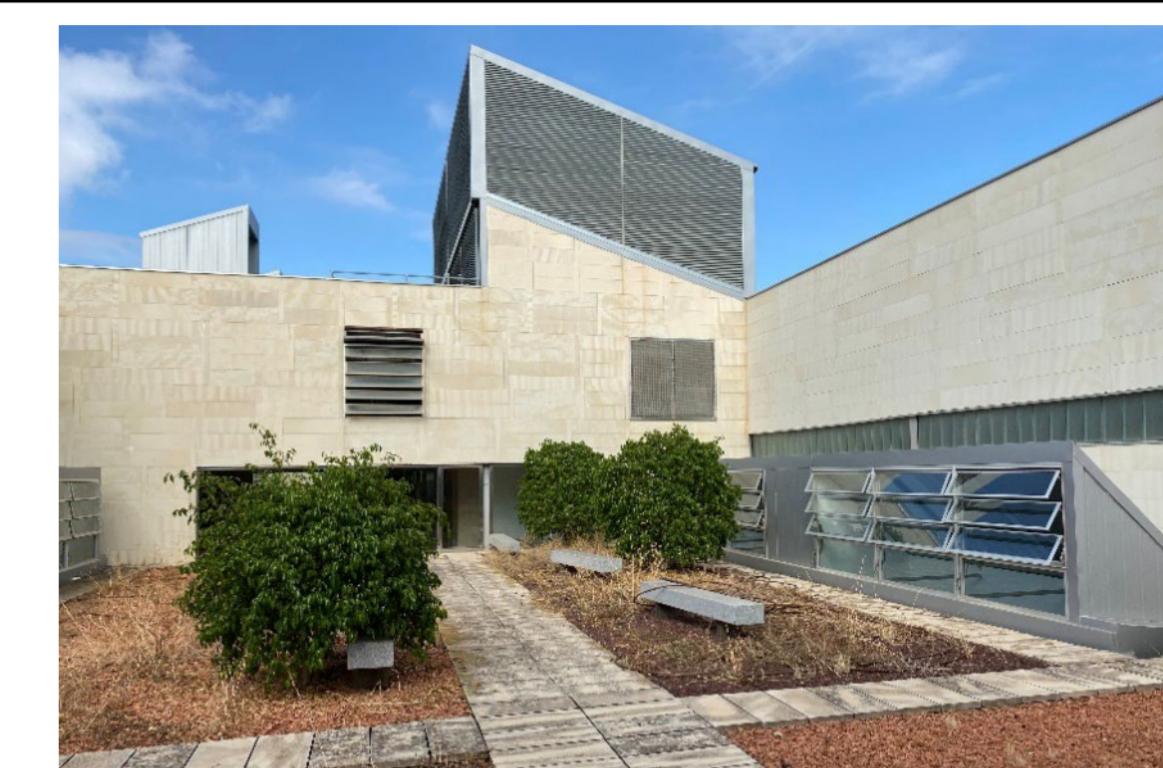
Cubierta ajardinada de estudio. Image 1. Green roof to study.
